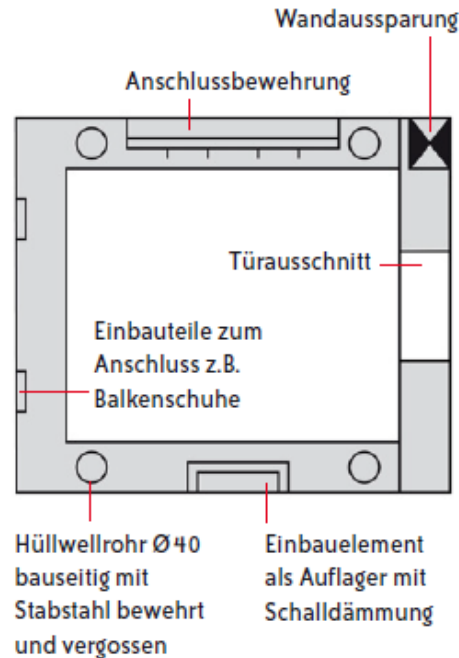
Sonderkonstruktionen – Aufzugsschacht
